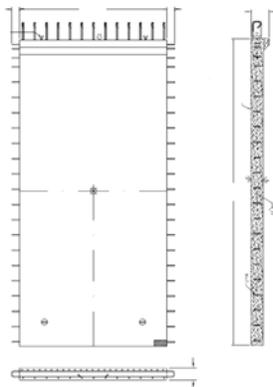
Sistema de paredes constituidas por paneles verticales de sección constante
